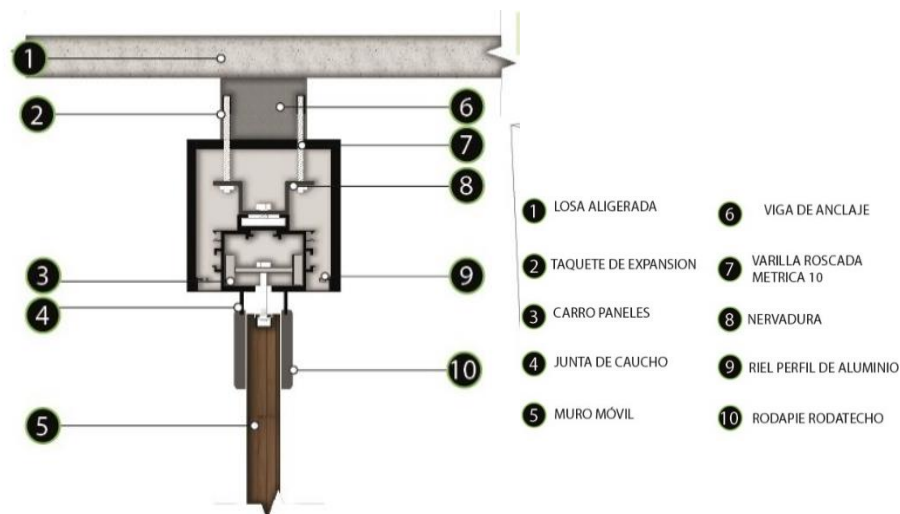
Detalle constructivo para la adaptabilidad de los muros móviles
